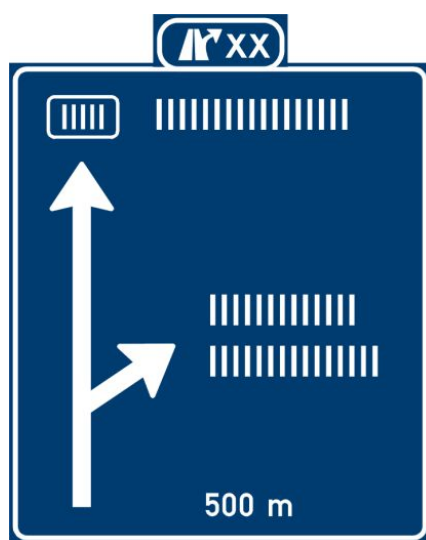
ODZ na dálnici před křižovatkou s jinou silnicí.
